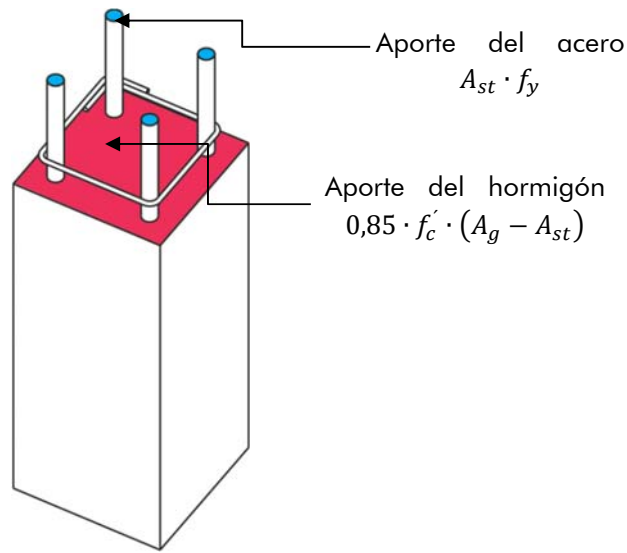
Componentes de la resistencia a compresión del hormigón armado
